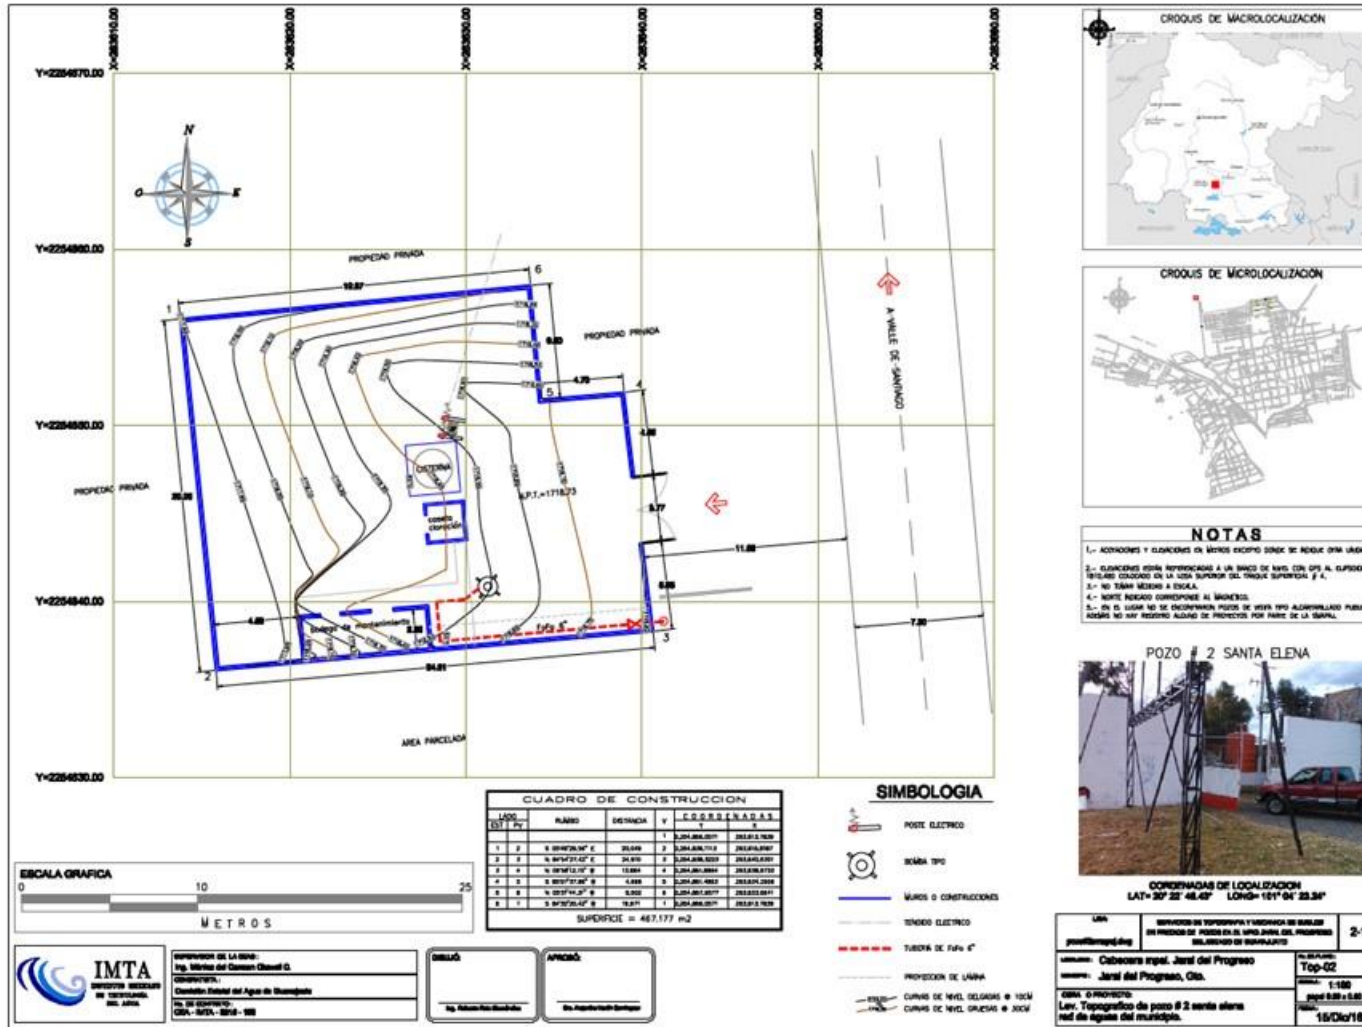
Levantamiento Pozo 2 (Ver anexo de planos para más detalle)
